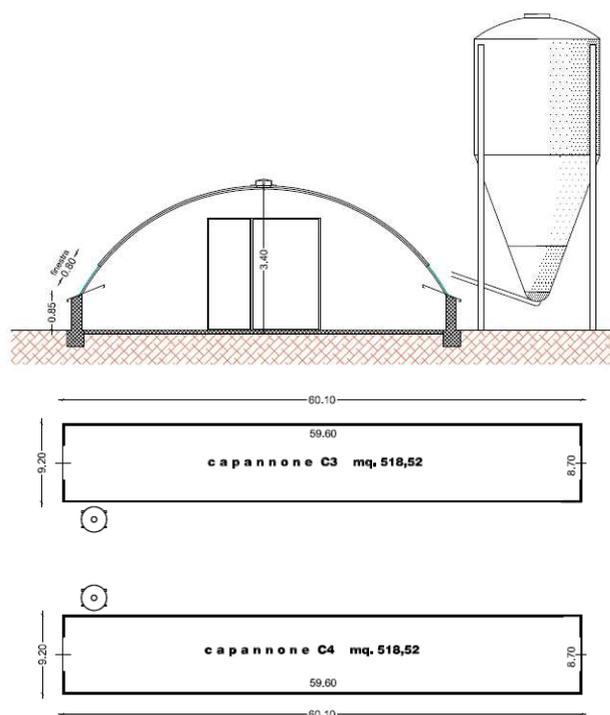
Sezione e pianta dei capannoni C3 e C4 (fonte: A. I. A.)
